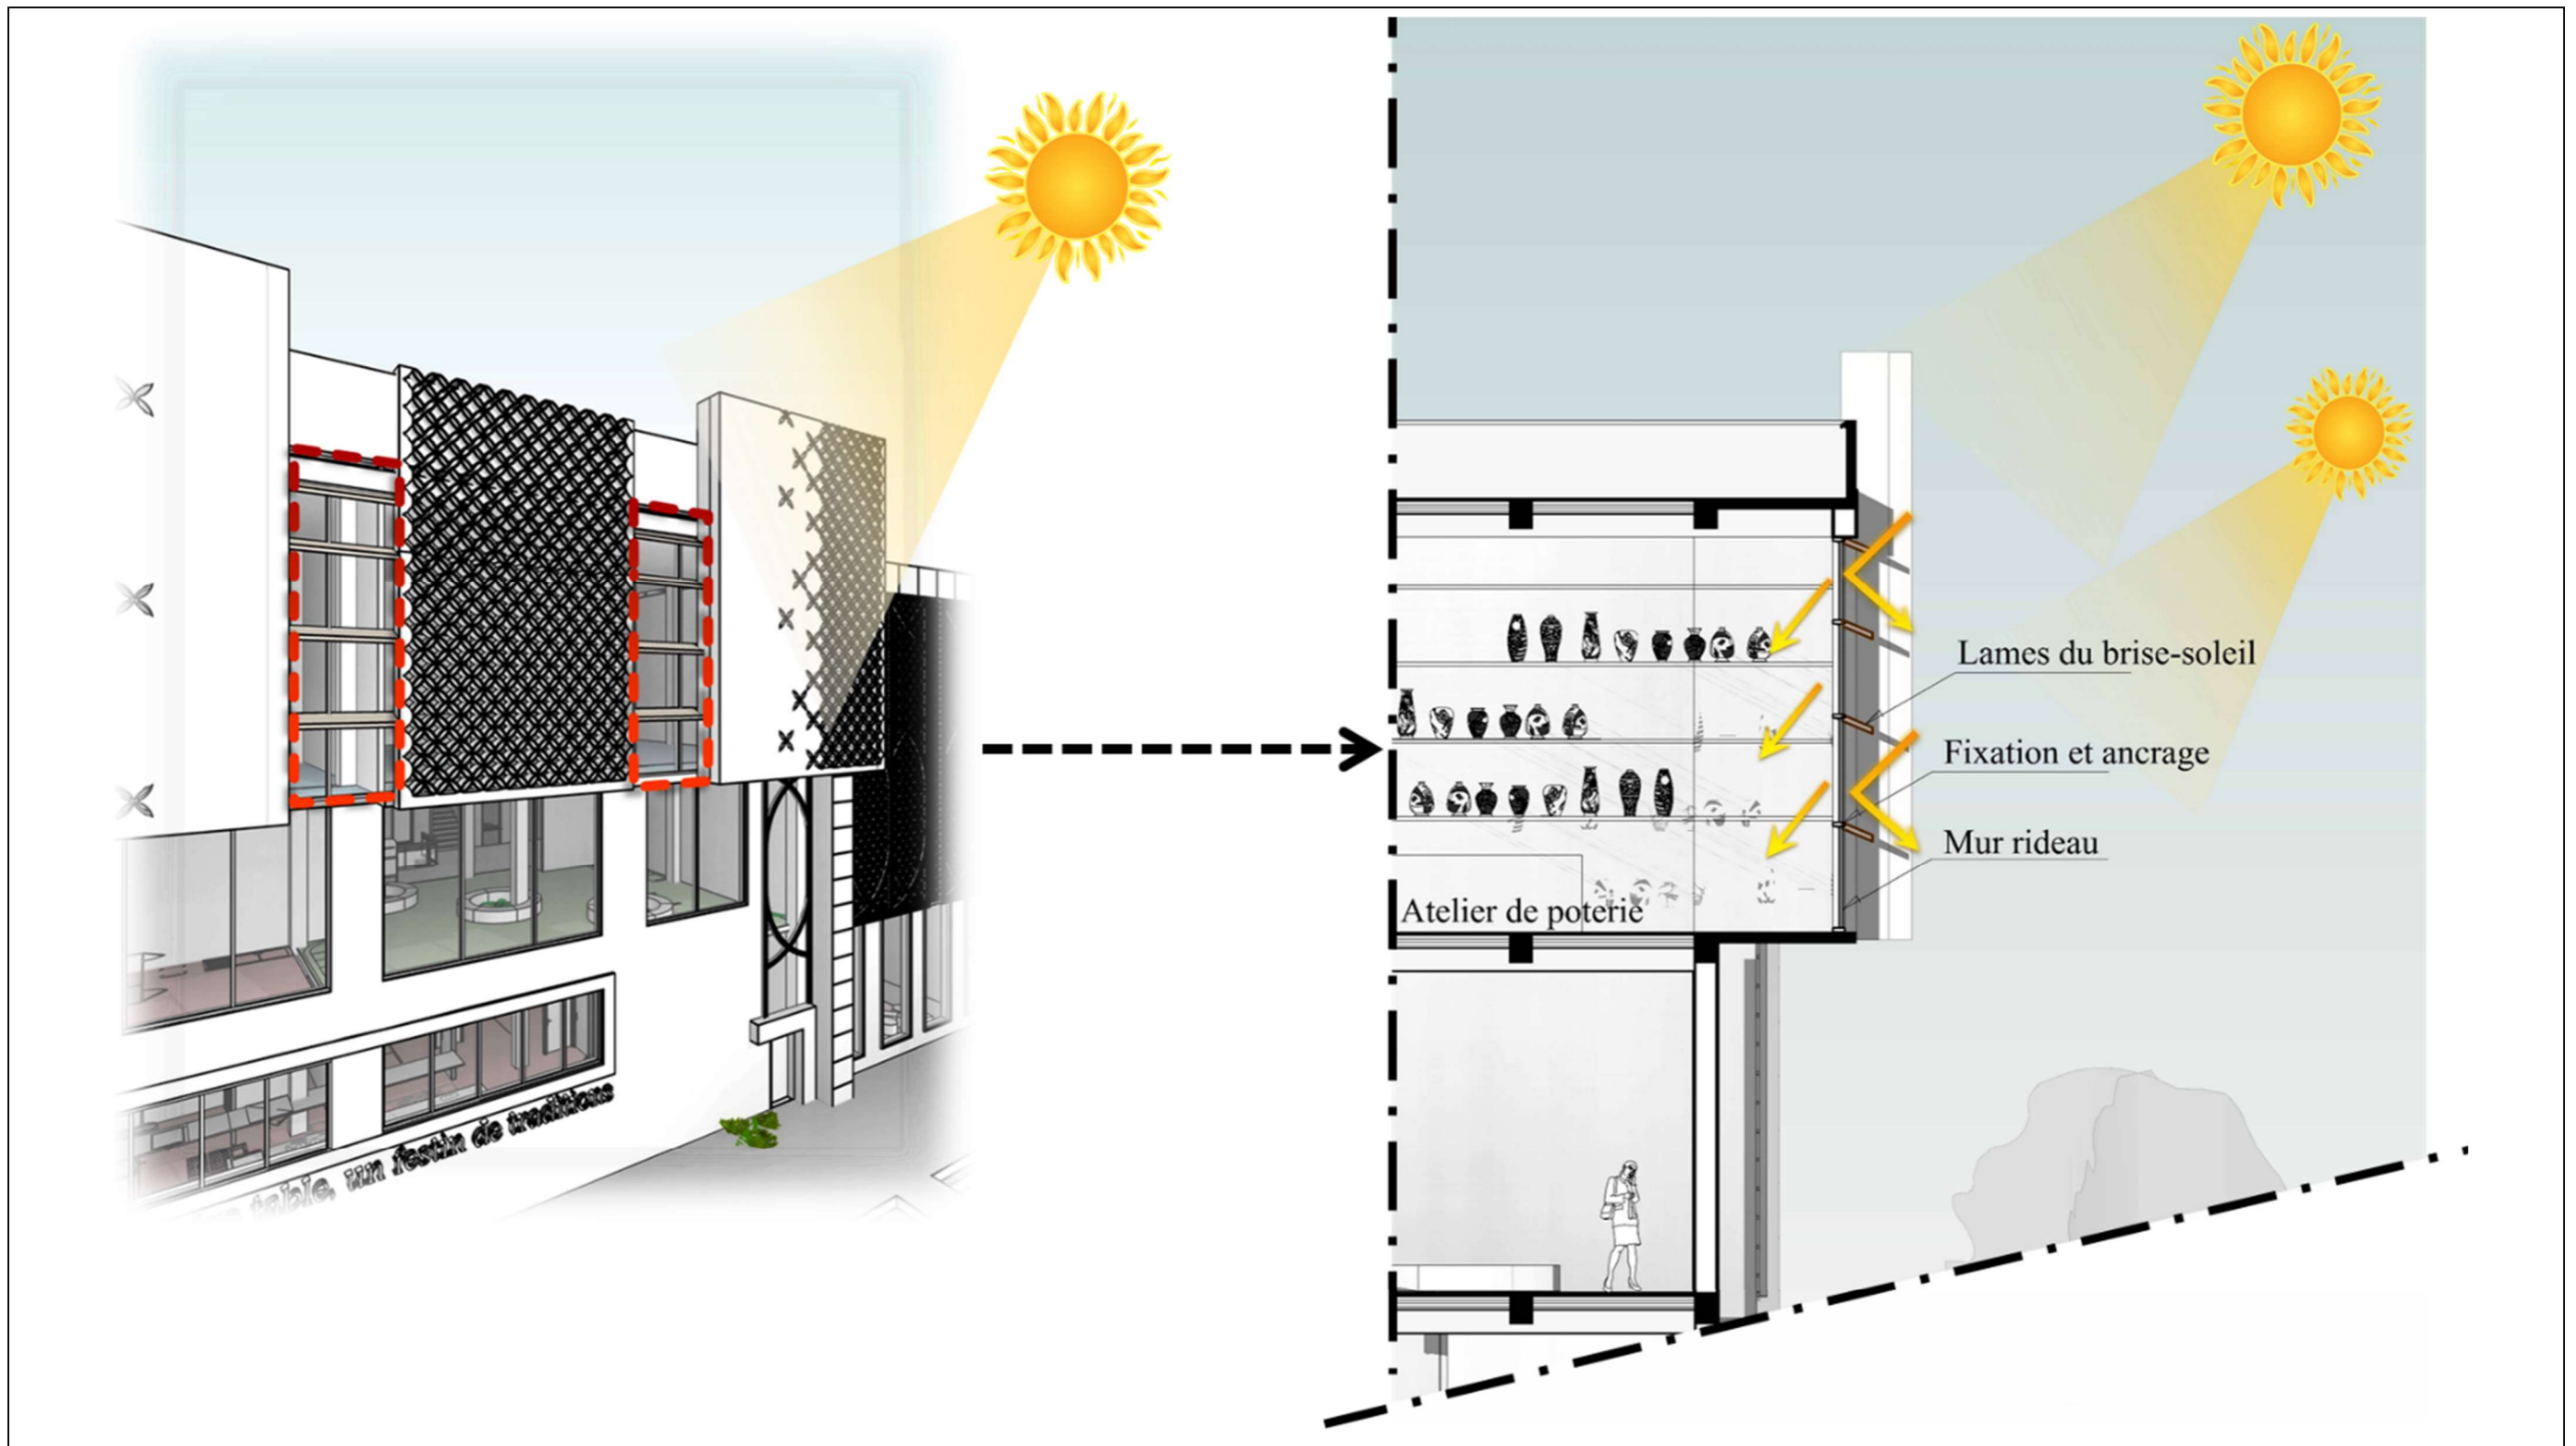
SCHEMA BRISE-SOLEIL HORIZONTALAUX
